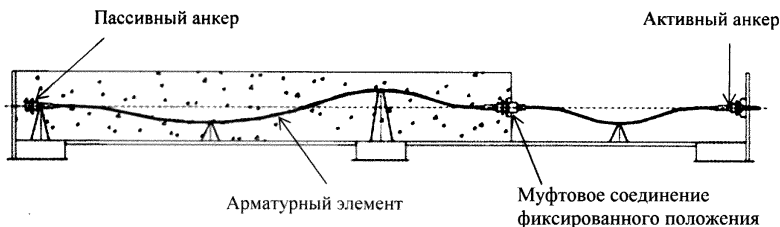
Устройство муфтового соединения в стыках смежных захваток монолитных конструкций
